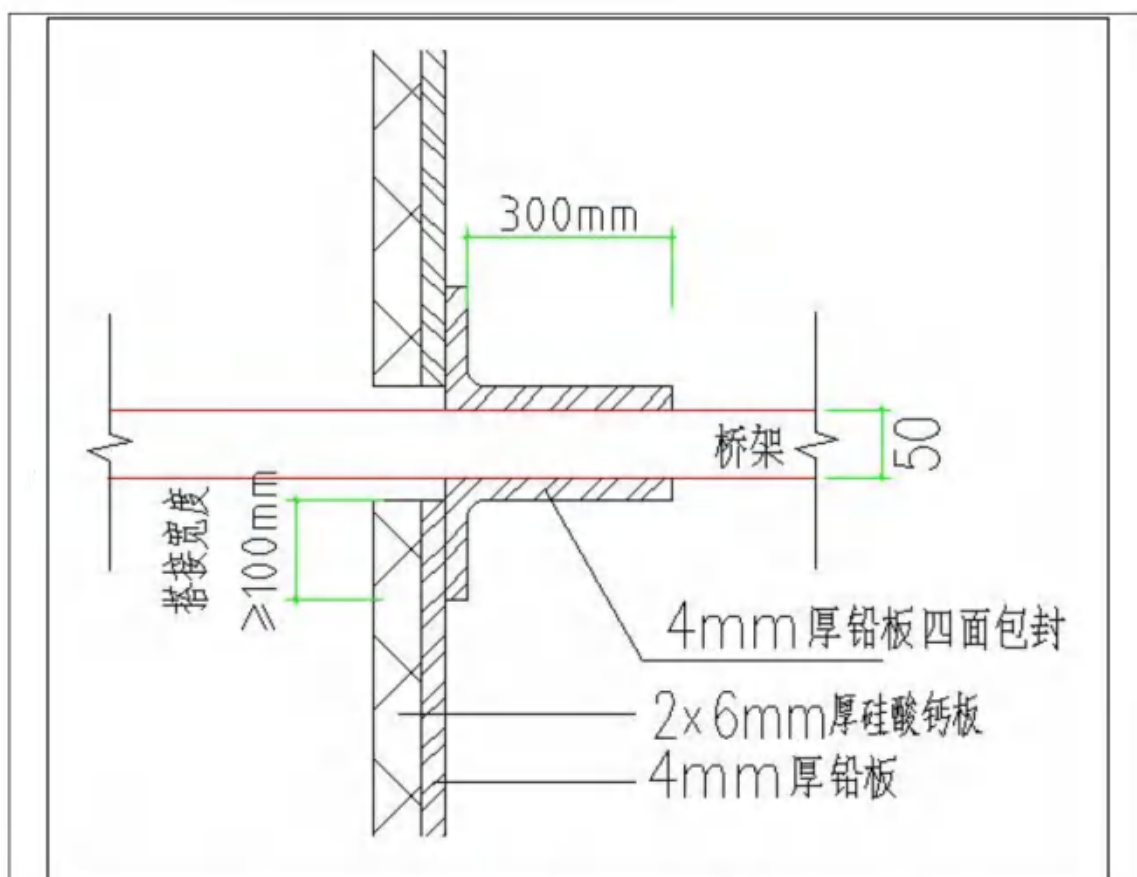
b 项目 DSA 机房电缆穿墙立面示意图
